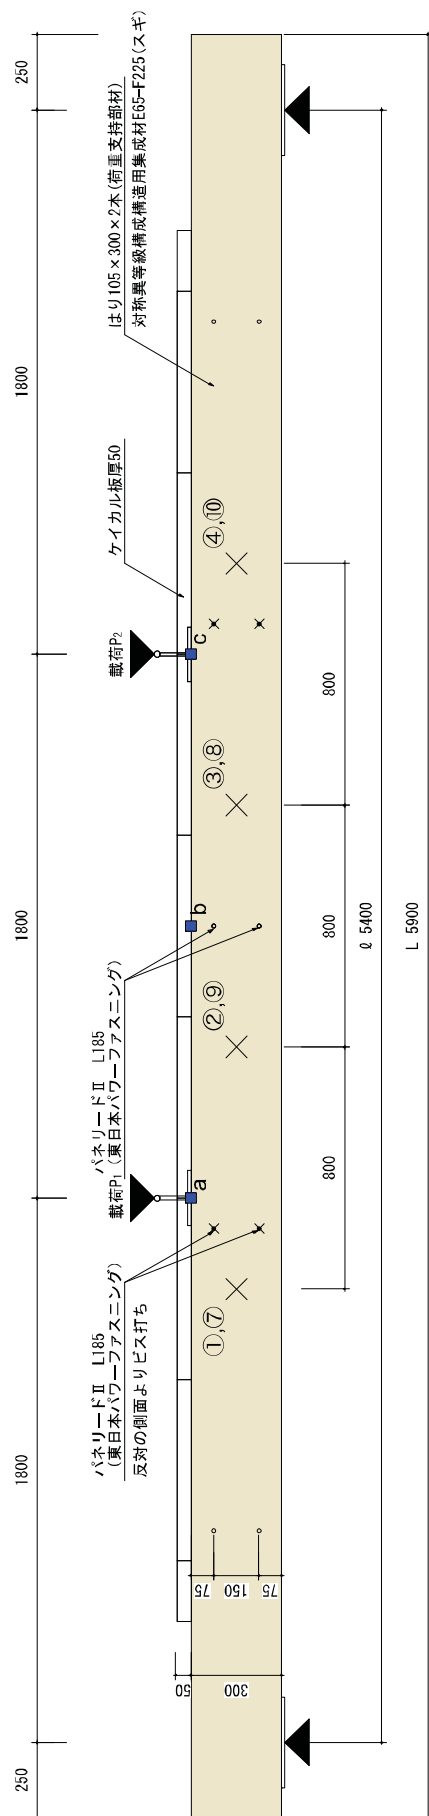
はり間の温度測定位置図 (試験体 TB-3)
